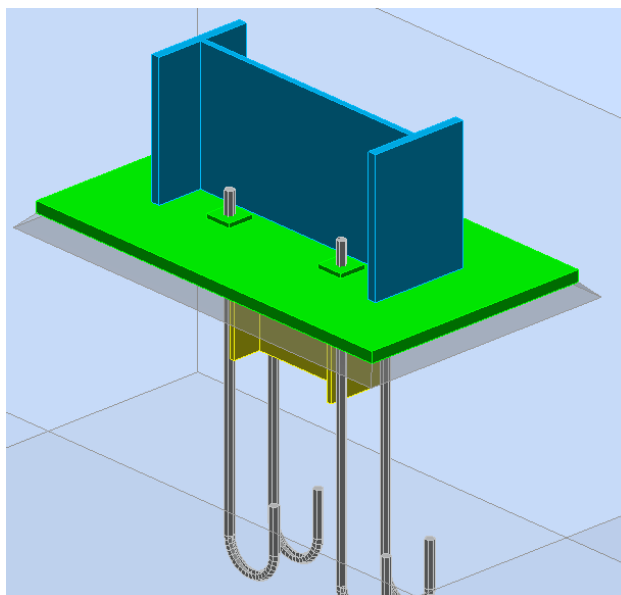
Unión de Pilar a cimentación mediante placa de anclaje
